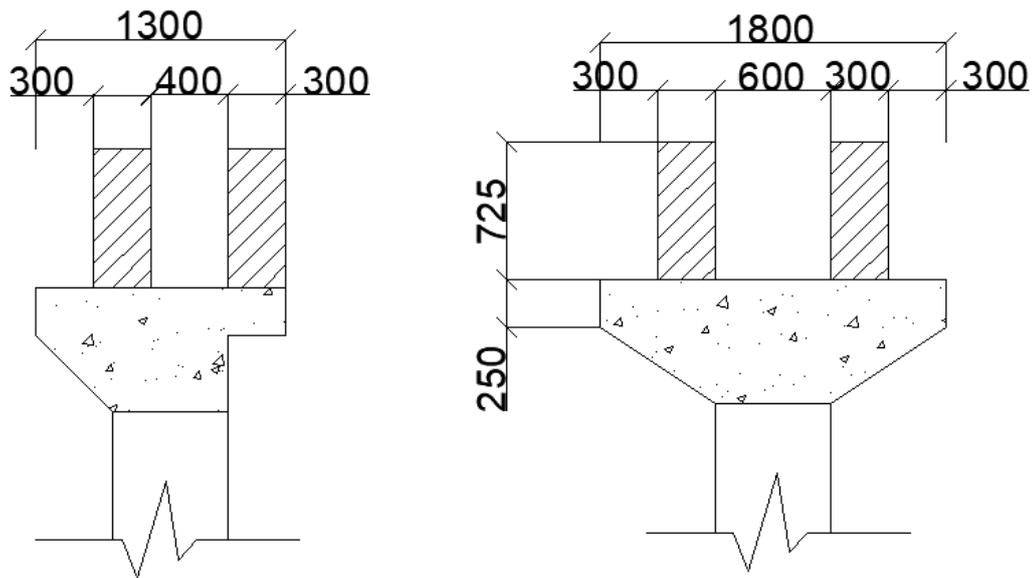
Betonagem da primeira fase (Viga-caleira)
